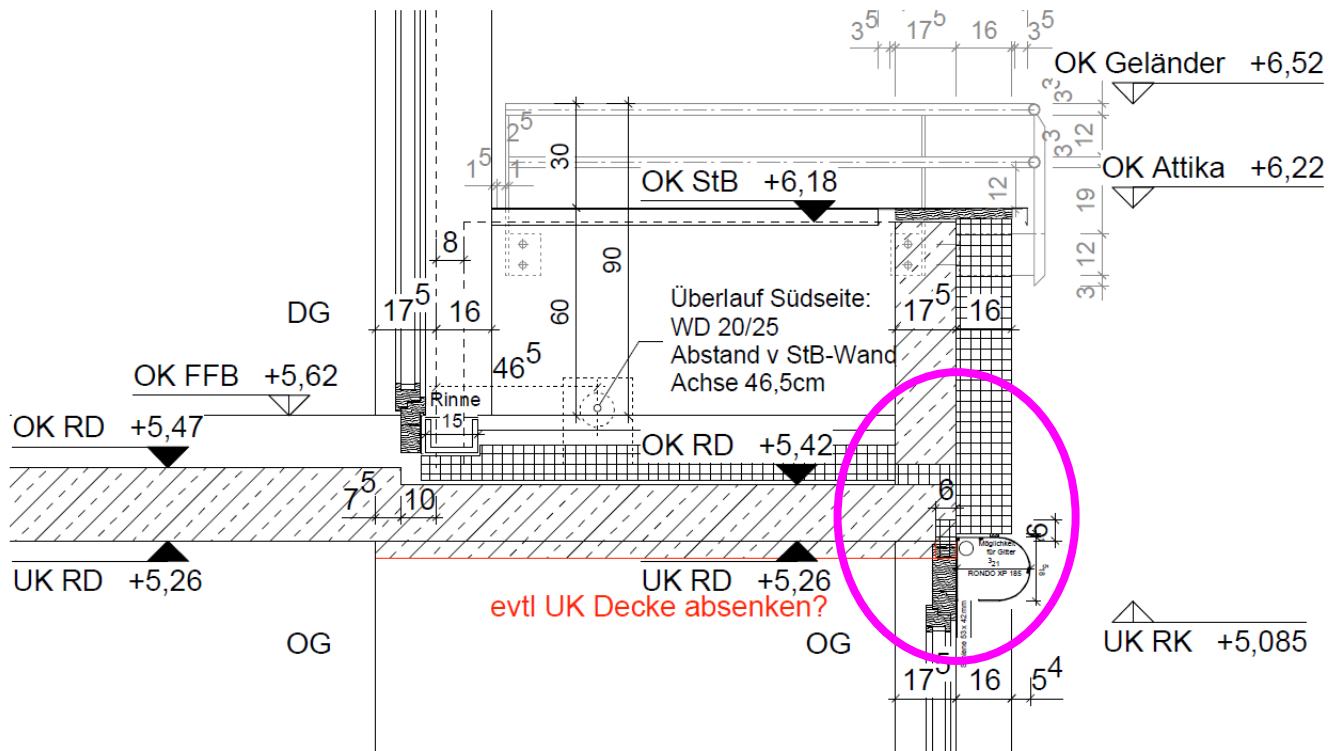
Handskizze, Terrassen-Brüstung mit thermischem Trennelement
